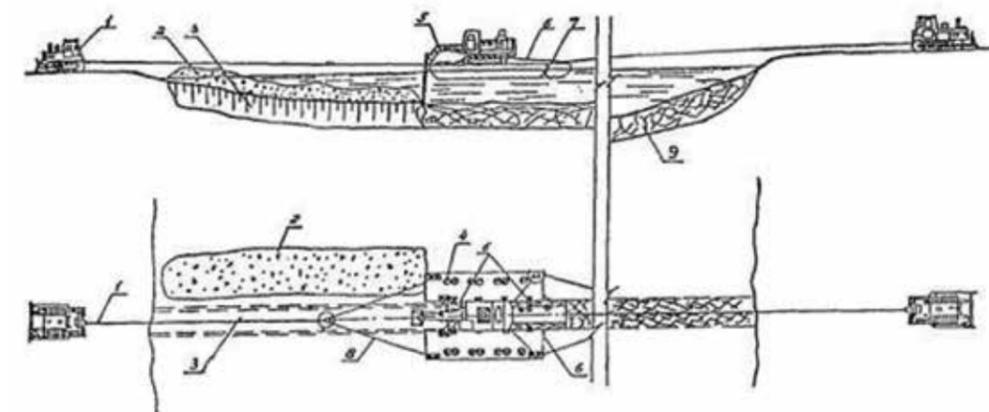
Схема разработки грунта с помощью экскаватора на понтоне для укладки трубопровода траншейным методом. 1 — трактор-тягач (может применяться лебедка); 2 — отвал разработанного грунта; 3 — траншея; 4 — смотровые люки на понтоне; 5 — экскаватор с удлиненной рукоятью; 6 — страховочные тросы; 7 — понтонная переправа; 8 — гашевые тросы; 9 — разрыхленный грунт
